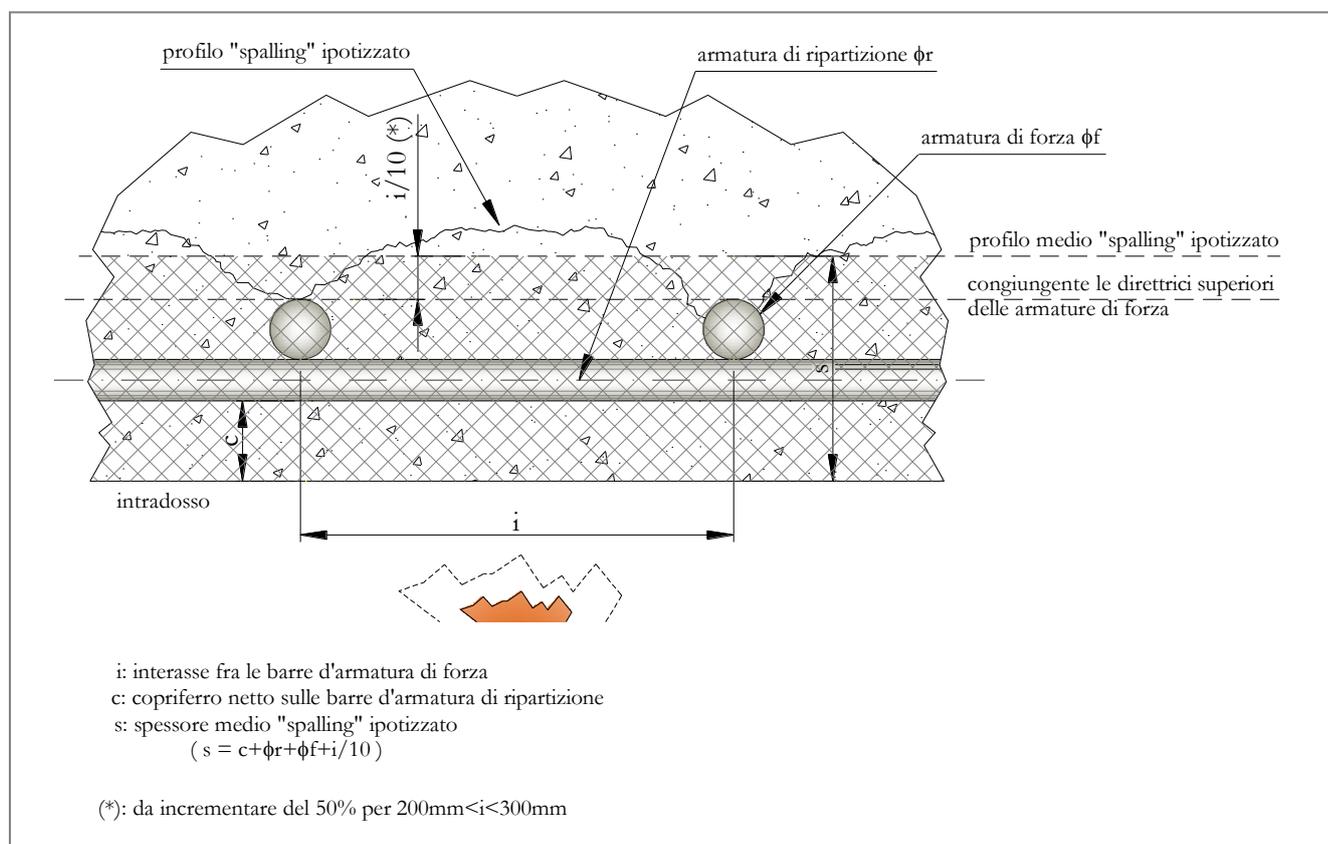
Stralcio schematico sezione strutturale per quantificazione fenomeno "spalling" da cfr. rif. [9]
